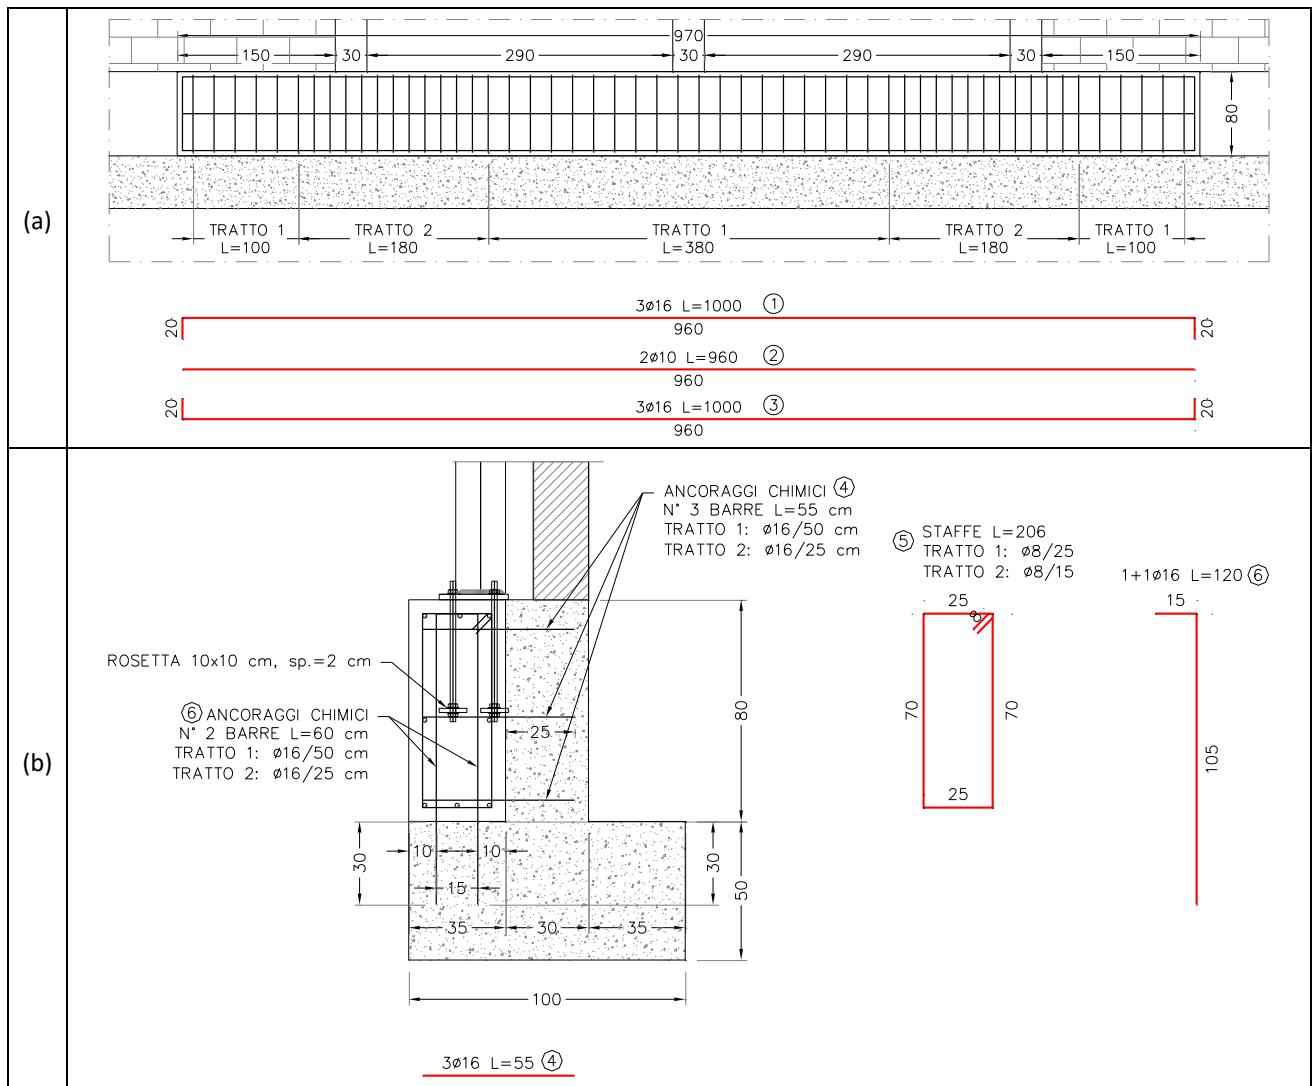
Nuovo cordolo di fondazione - sezione frontale (a) e trasversale (b)
